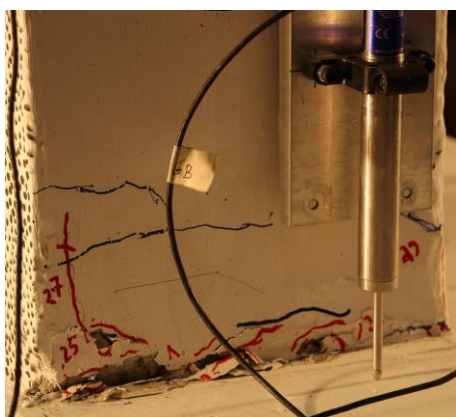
Fissures verticales de compression sur la face latérale droite de la colonne C2B au LS31
